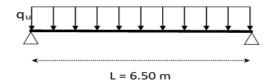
Schéma statique La poutre secondaire la plus sollicitée
